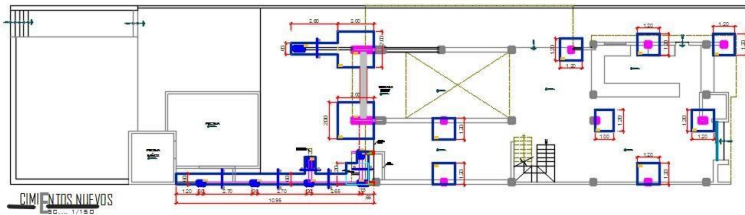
Plano de Propuesta de Cimientos Nuevos para Reforzar.
